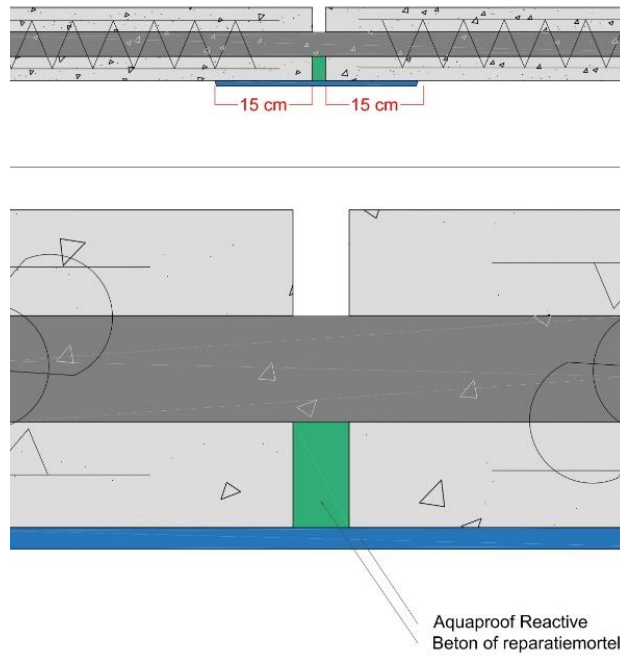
Waterdichting ter hoogte van een verticale naad in een geprefabriceerde betonnen wand
